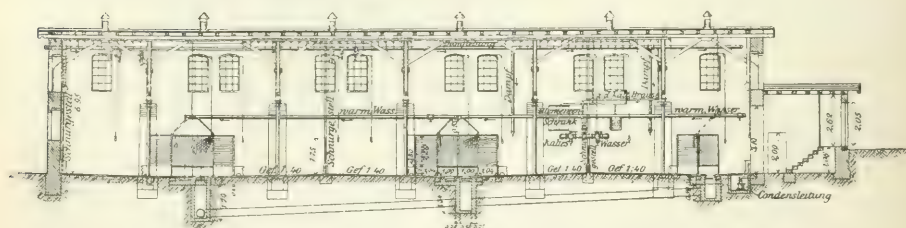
Brausebad auf Grube Dudweiler. Längsschnitt.
